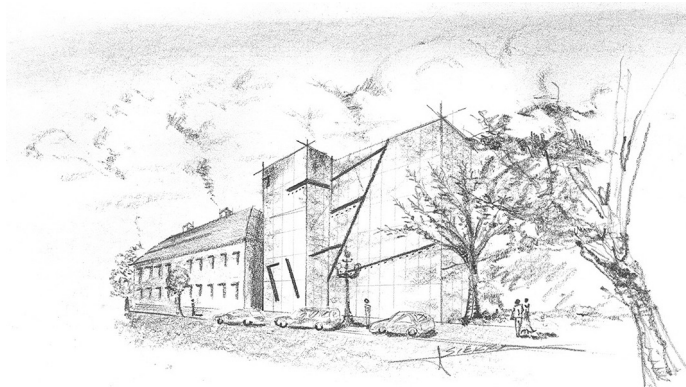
Antítesis evidente en la ruptura entre el edificio barroco y la propuesta deconstructivista.
